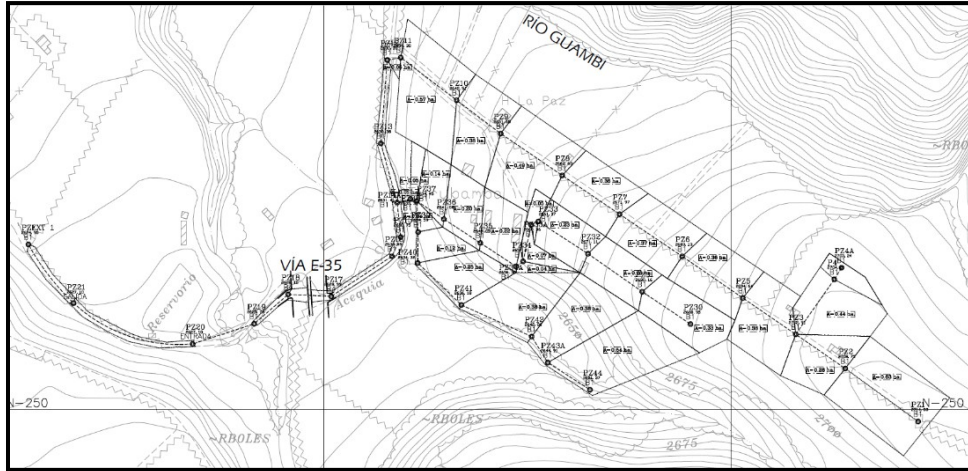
Áreas de aporte para el sistema de alcantarillado
